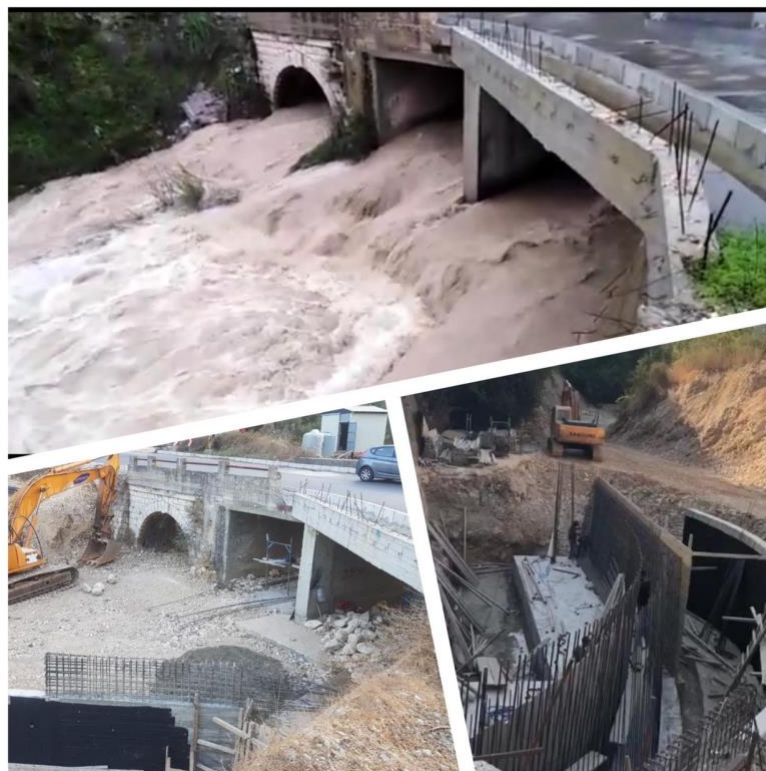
les travaux de construction dans la rivière de Ghalboun. Source TERRE Liban
